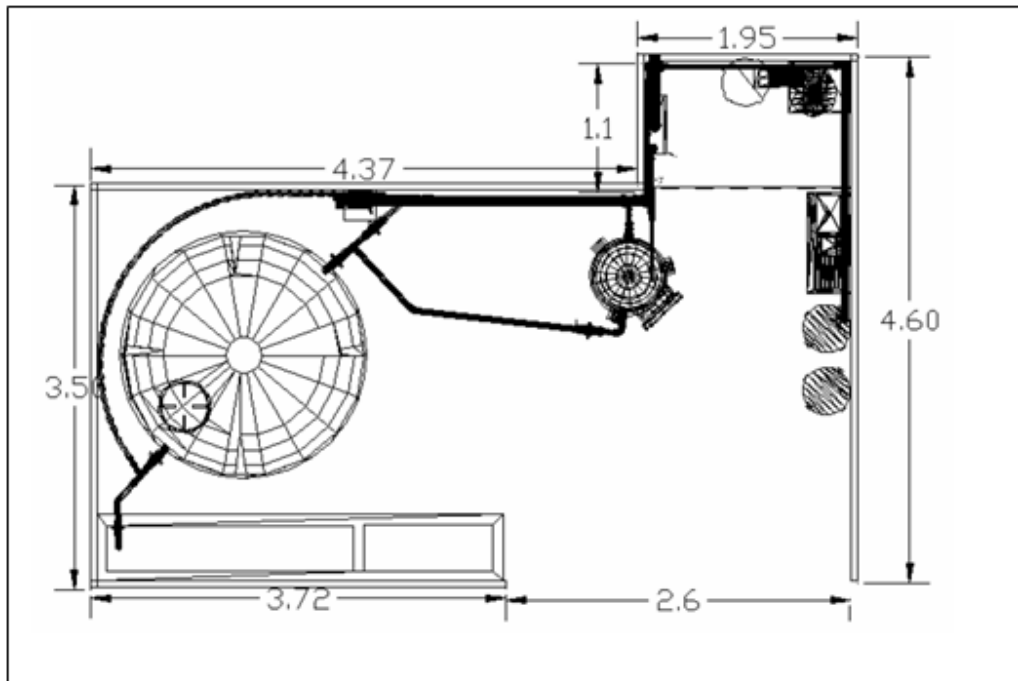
Plano con acotaciones vista superior referente a muros de la planta de biogás (Juárez-Hernández, 2011)
